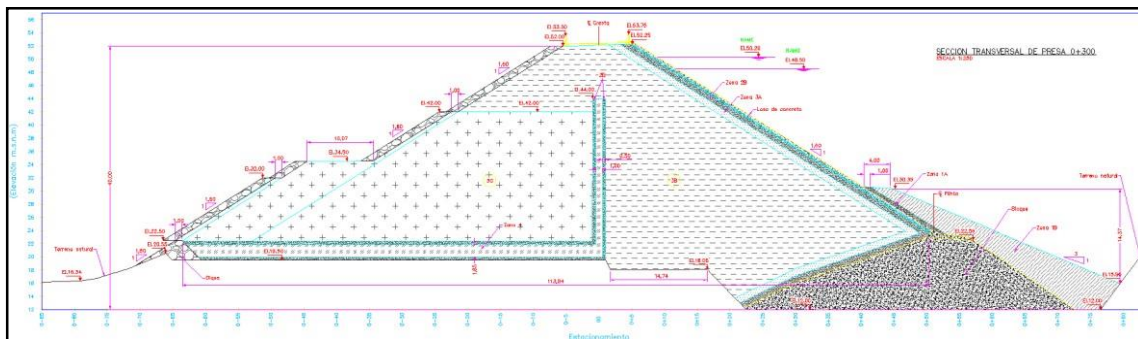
7. Propuesta Presa enrocado con Cara de Concreto Paacume
